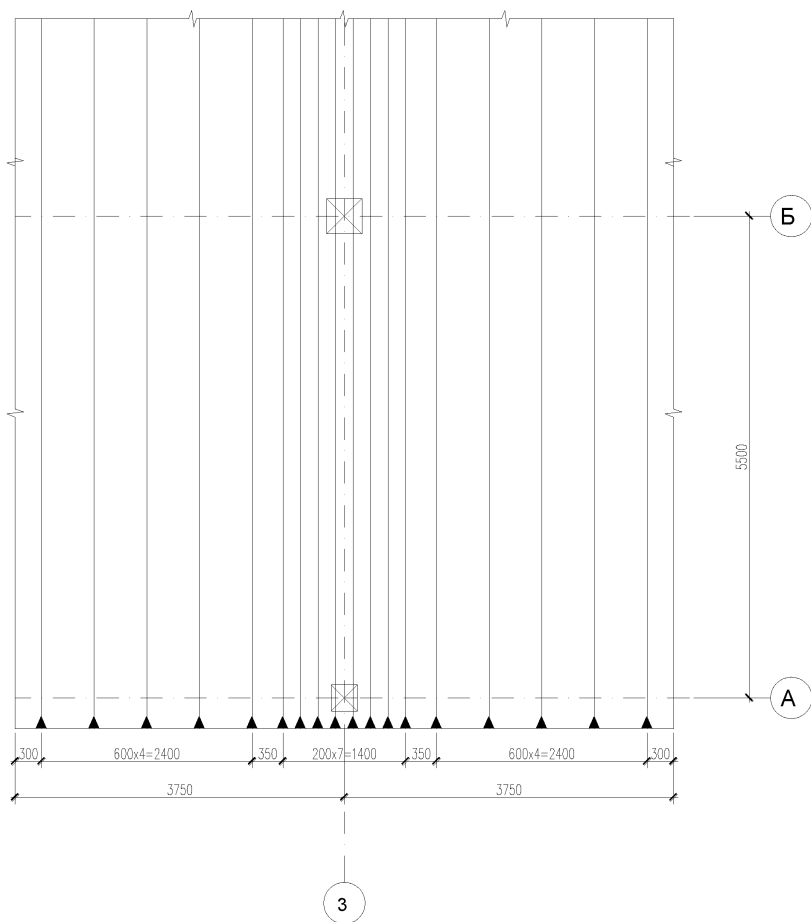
Конструирование расположения арматурных элементов вдоль буквенных осей
